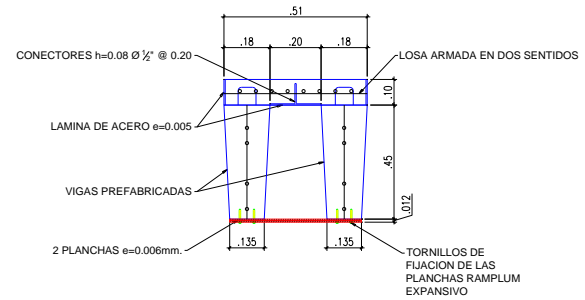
Sección transversal reforzada de Tablero de Puente (m).
